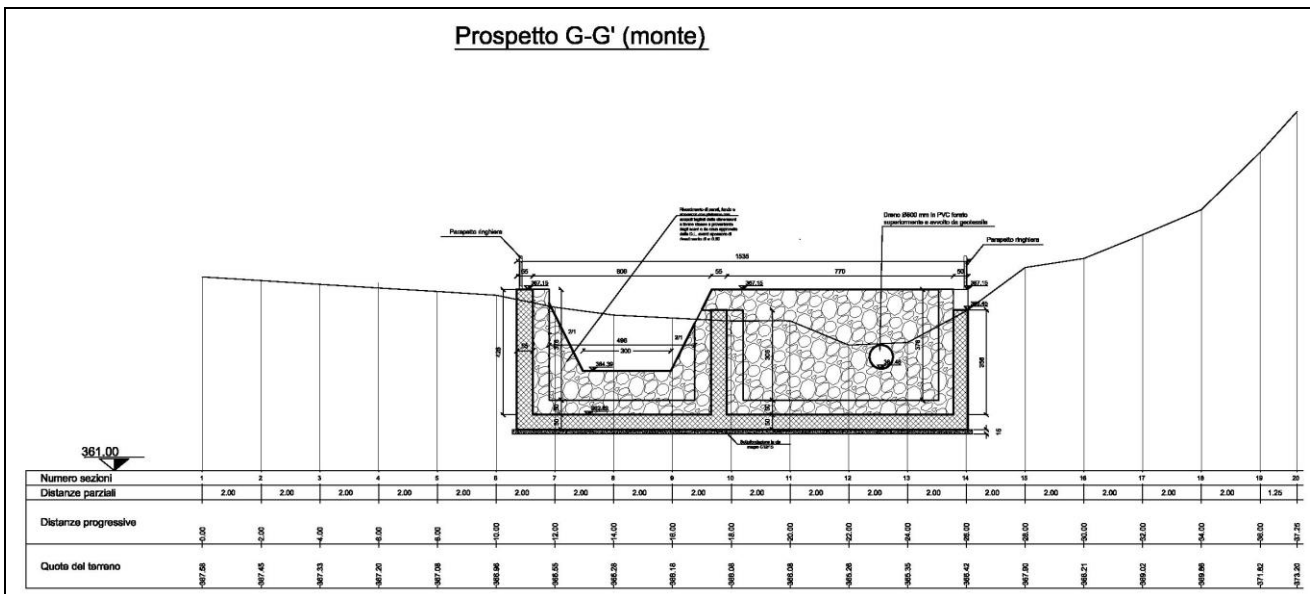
Compluvio nord – Vasca di sedimentazione - sezione
